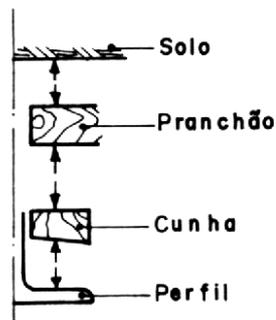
Maneiras de se instalar o pranchão em escoramento tipo Berlinense (Perfil metálico-pranchão)
